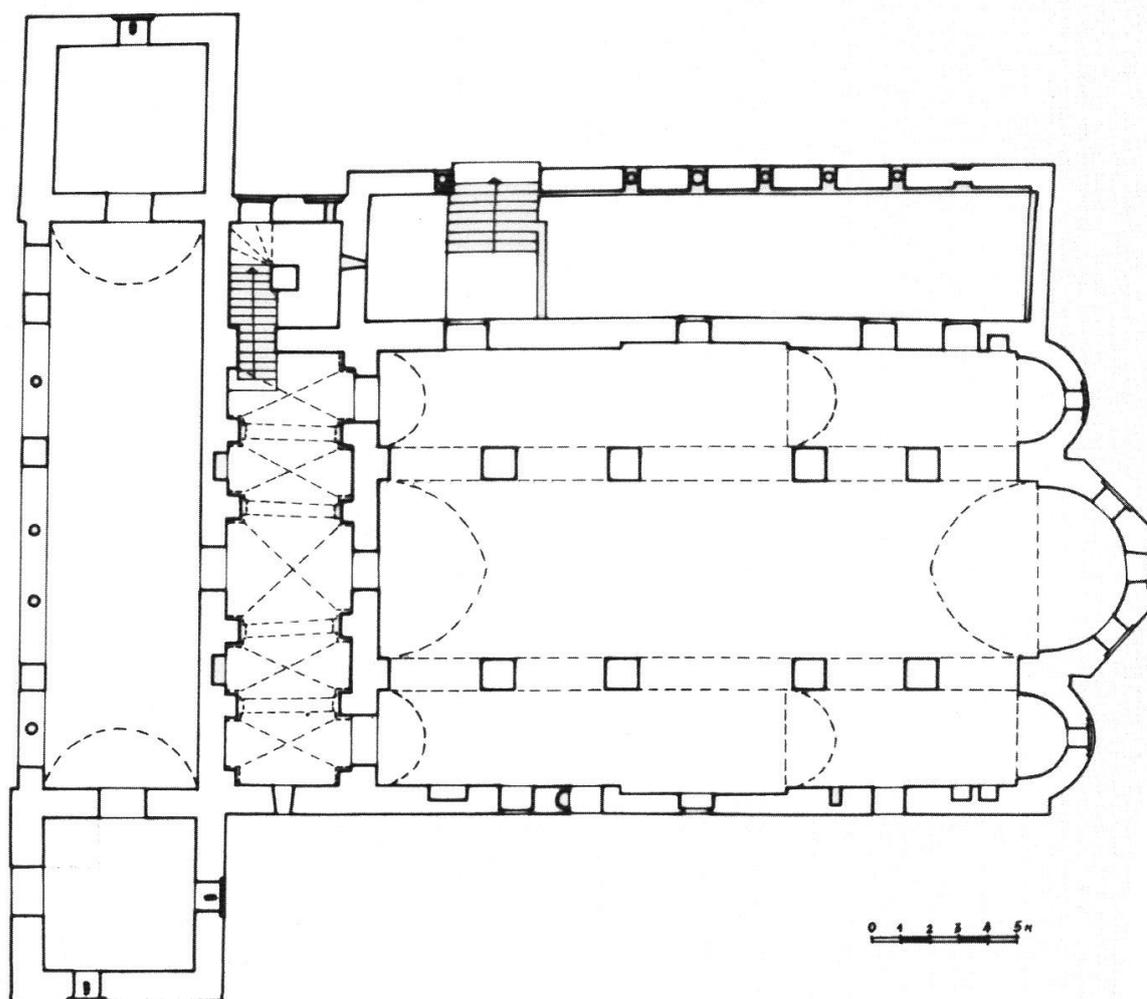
La planta baja de la iglesia de Santa Sofia, estado actual.
